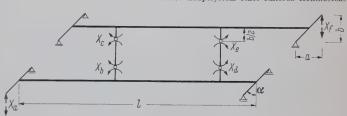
Statisch bestimmtes Hauptsystem für zwei durch Querträger miteinander verbundene schiefe Hohlkästen
